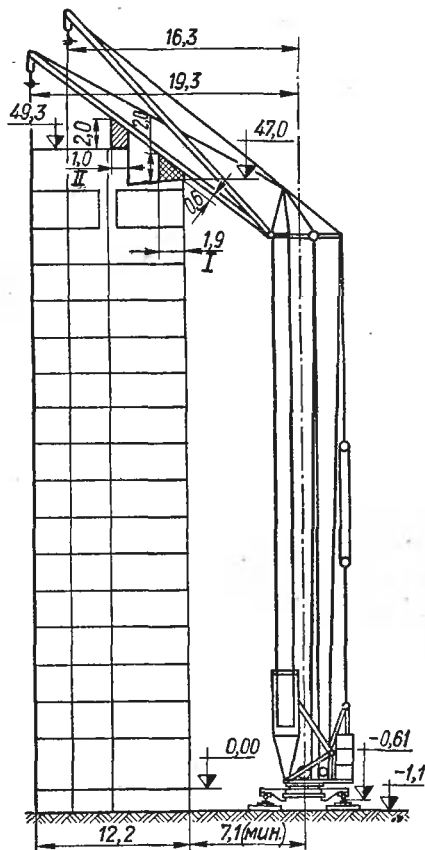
Установка башенного крана КБ-160.2 при монтаже здания методом отступления (размеры в м):
